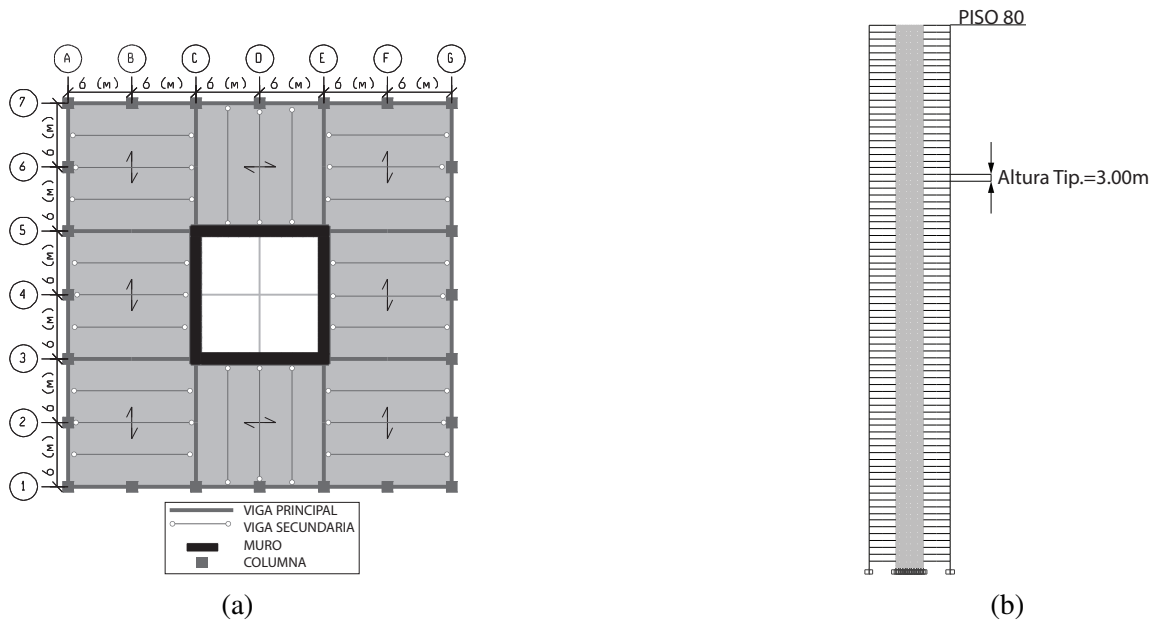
Geometría típica de edificio analizado. (a) Distribución de elementos en planta típica (b) Elevación del edificio sin *outriggers*.
